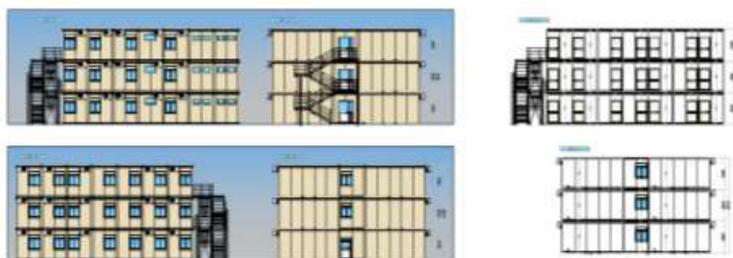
Stralcio piante, prospetti e sezioni delle opere (da elaborato: “Baraccamento Ufficio – Magazzino e Officina”)
